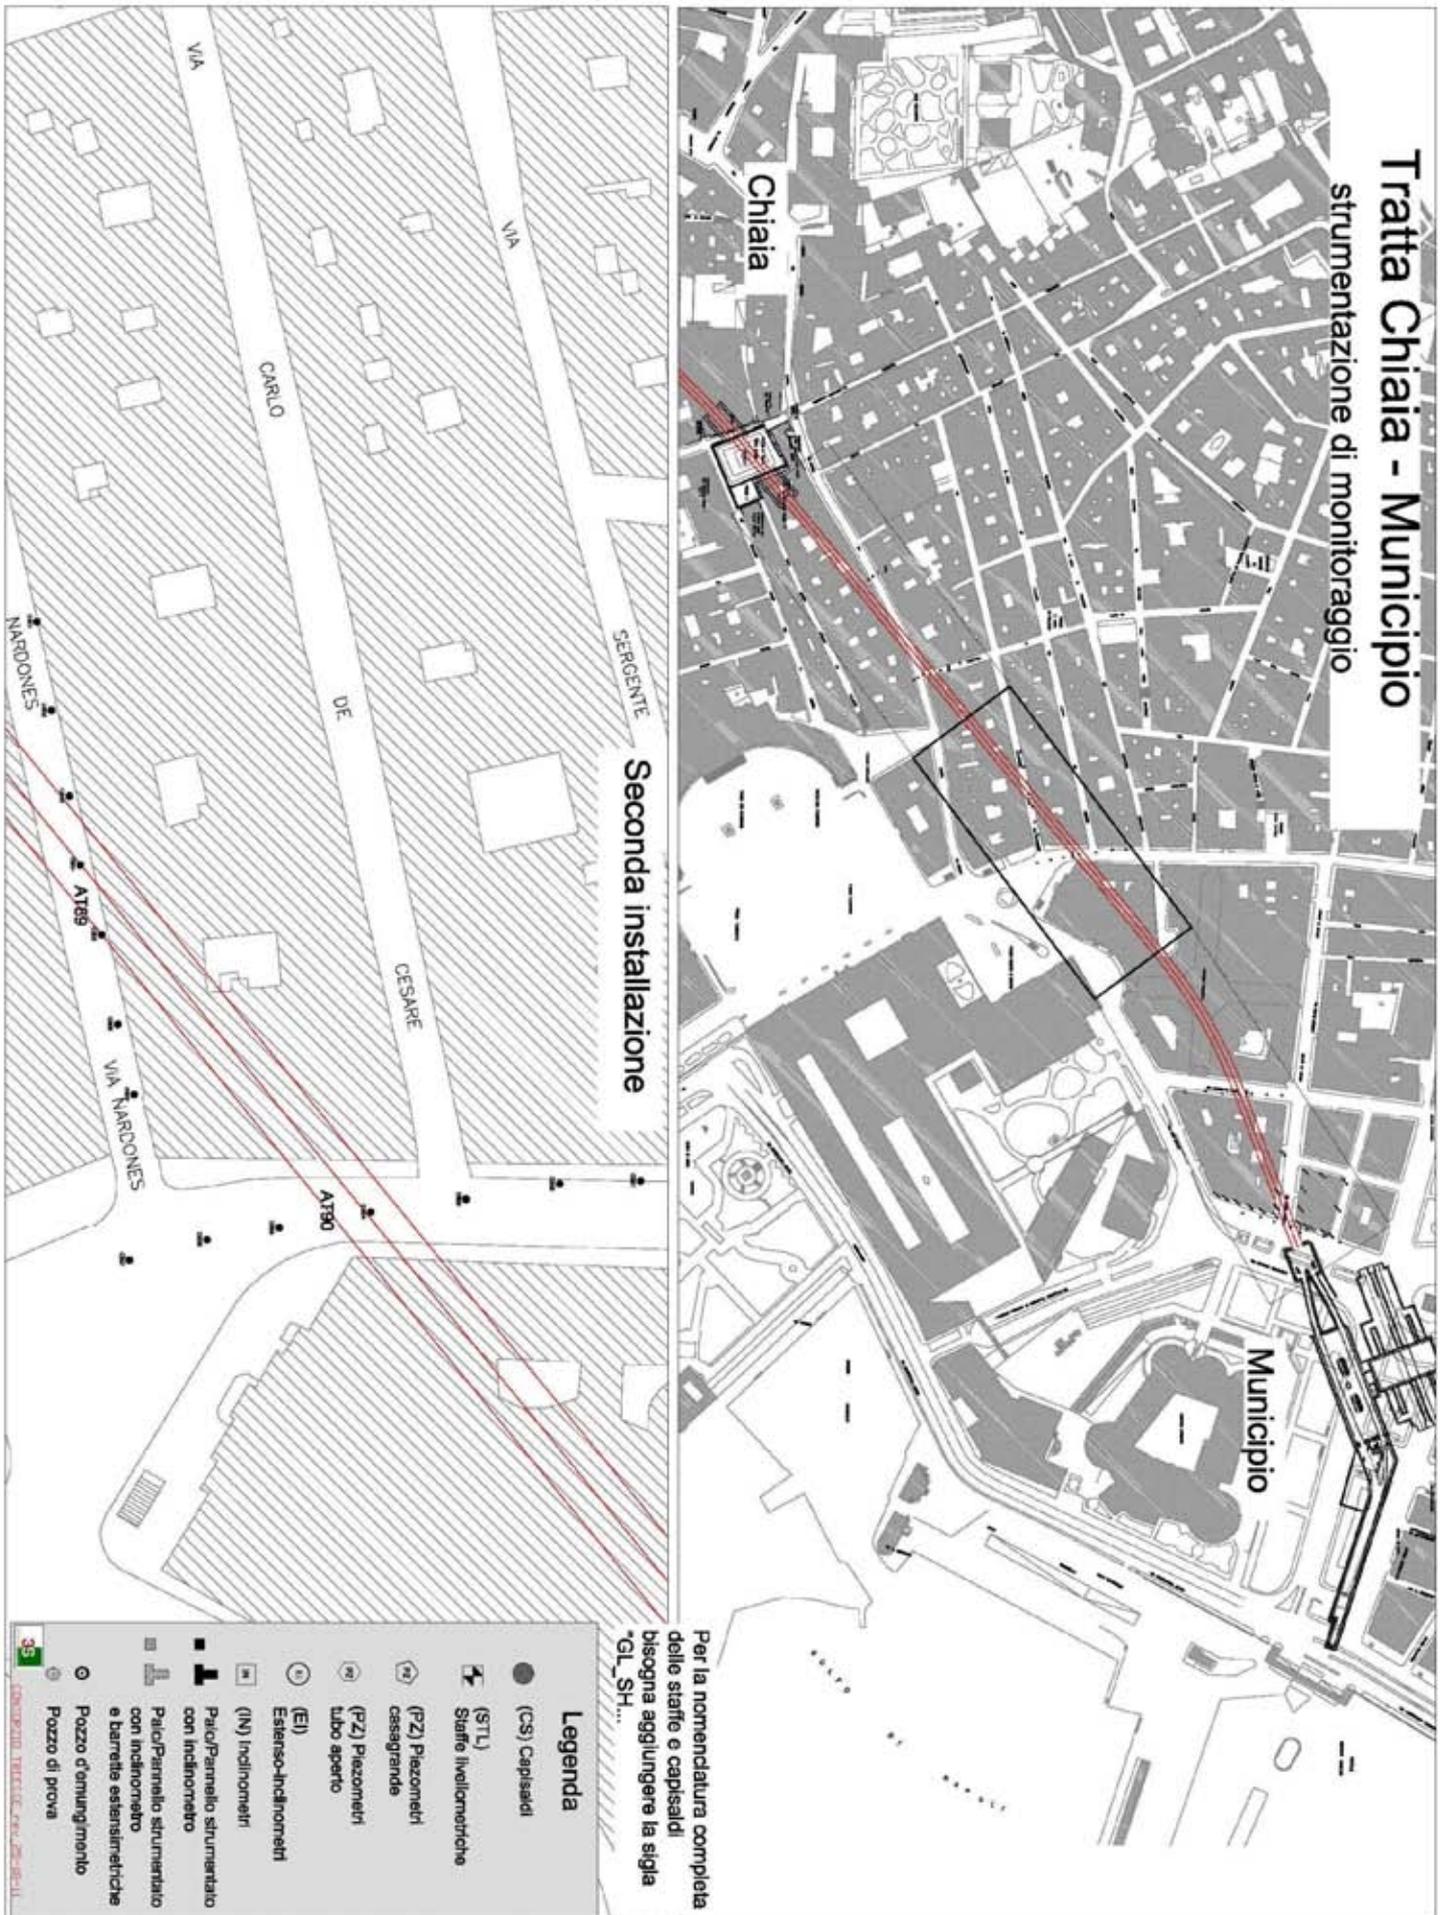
Planimetria tratta Chiaia - Municipio, raffigurante la disposizione della seconda installazione della strumentazione di monitoraggio.
